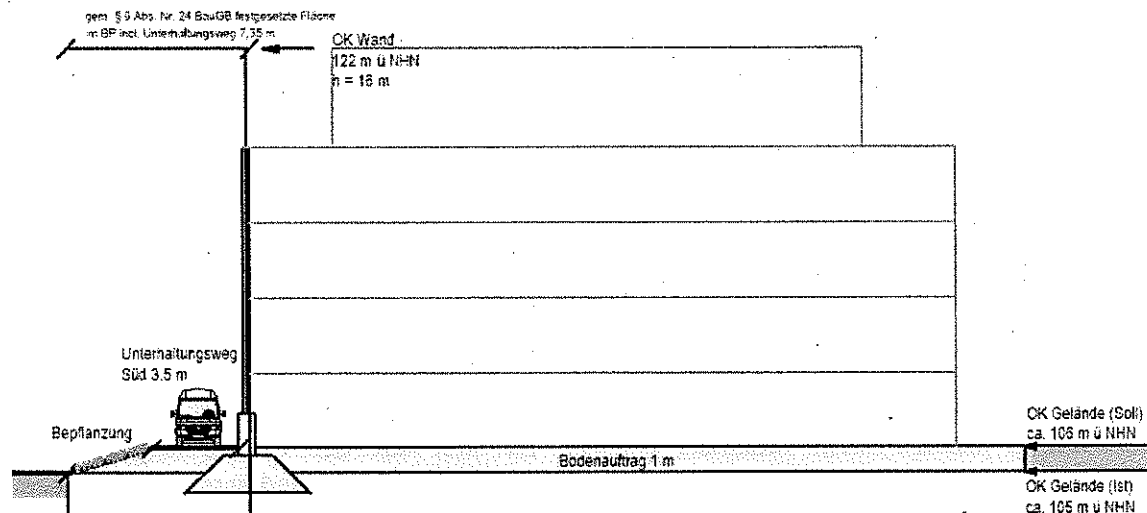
Schemaschnitt durch die südlich gelegene Bauzeile, die Planstraße B sowie die Schallschutzwand, Stand Oktober 2017
